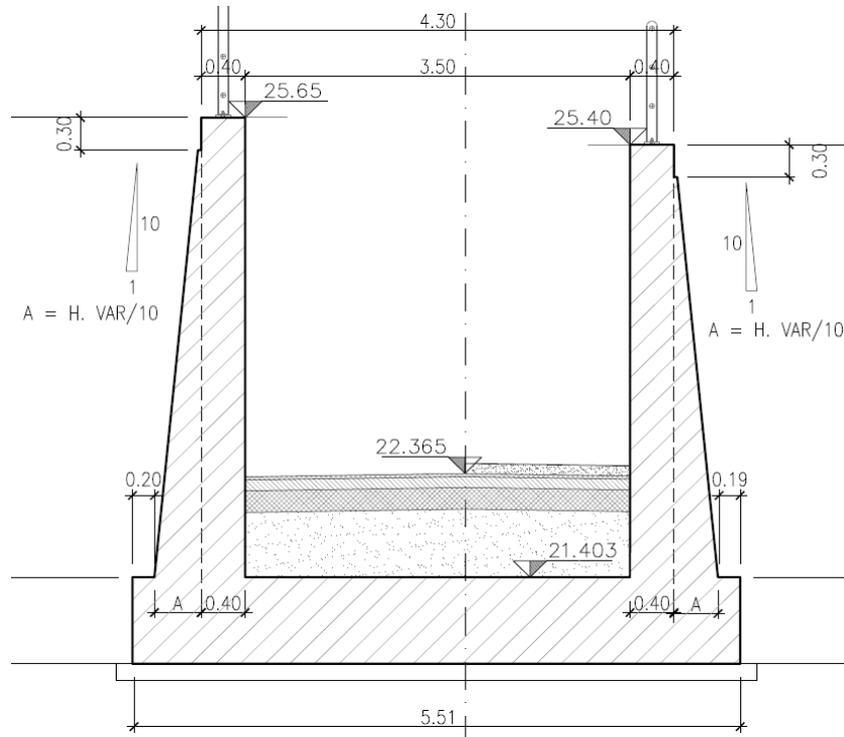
Muro di sbocco/imbocco ad U - Sezione trasversale
